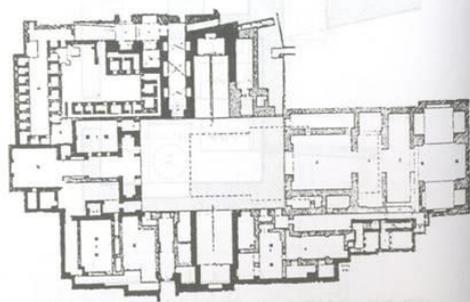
مسقط أفقي لبقعة رقية دودو (عن سوسن سليمان) -
